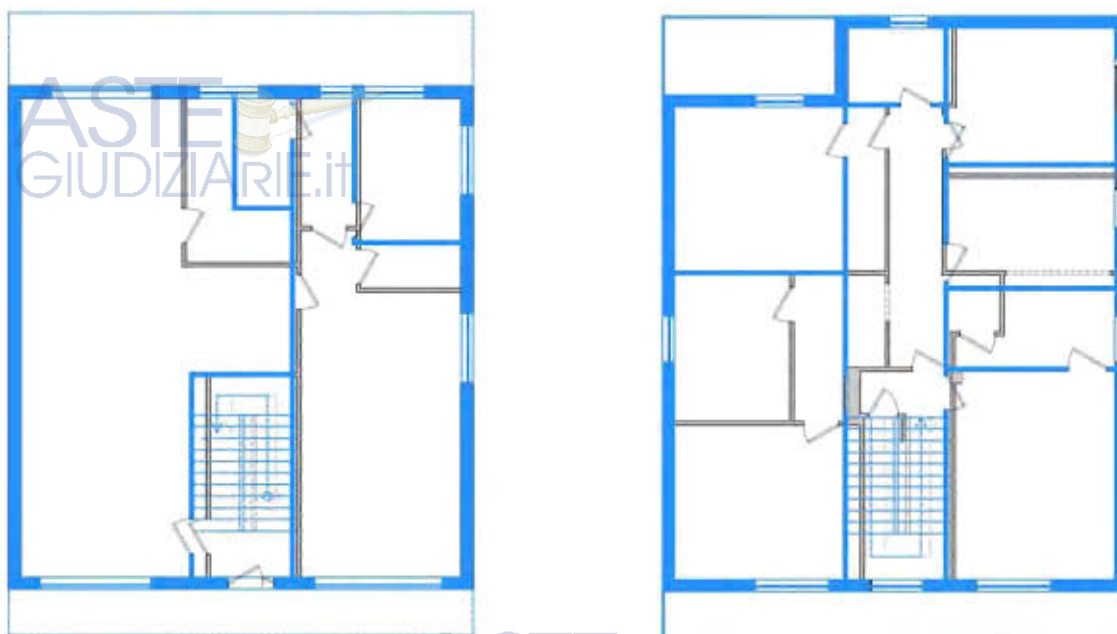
Sovrapposizione planimetria richiesta in sanatoria (in azzurro) su rilievi dello stato di fatto
